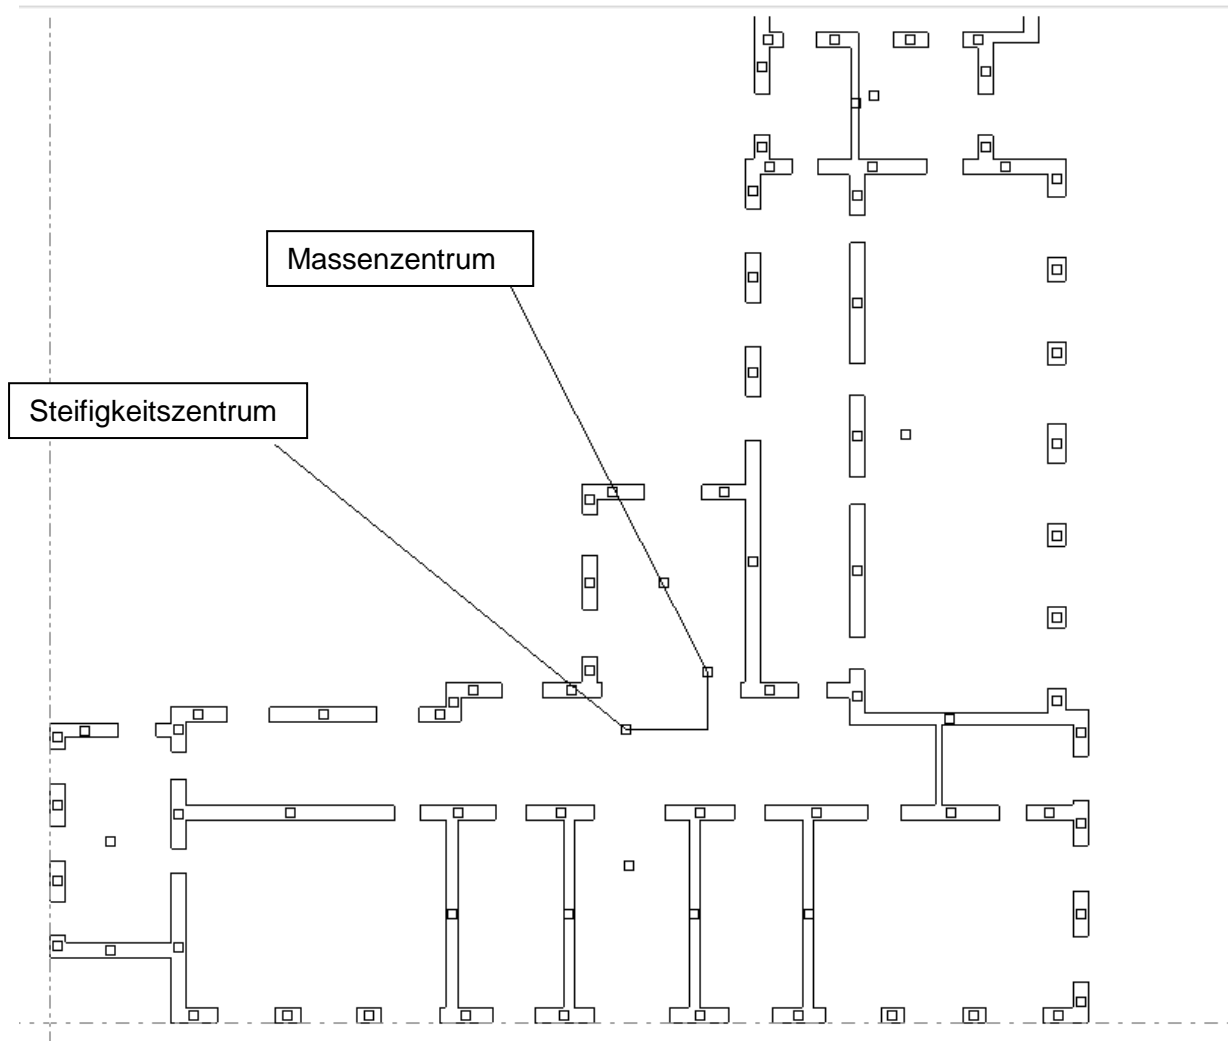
Grundriss EG – Tragende Mauerwerkswände
